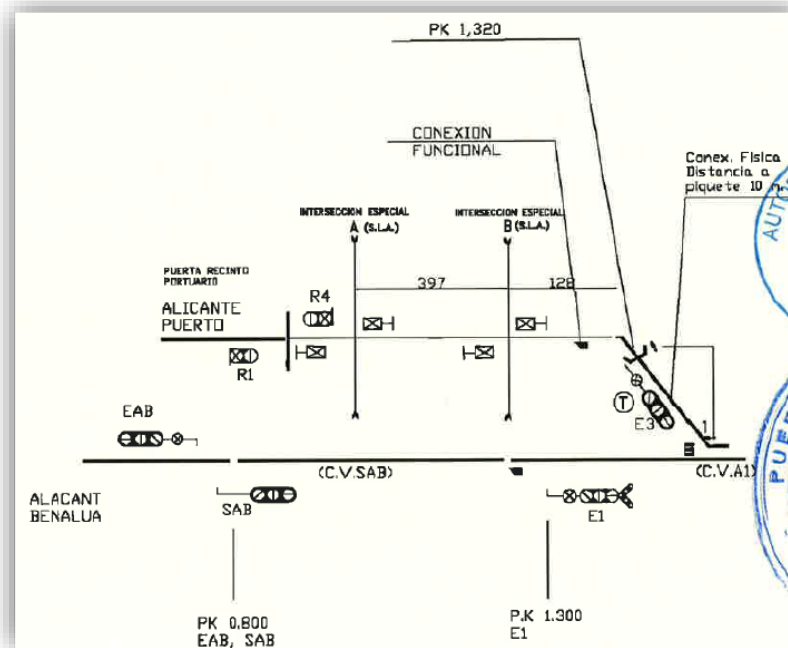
Esquema instalaciones de acceso al Puerto. Fuente: Convenio Conexión APA.
